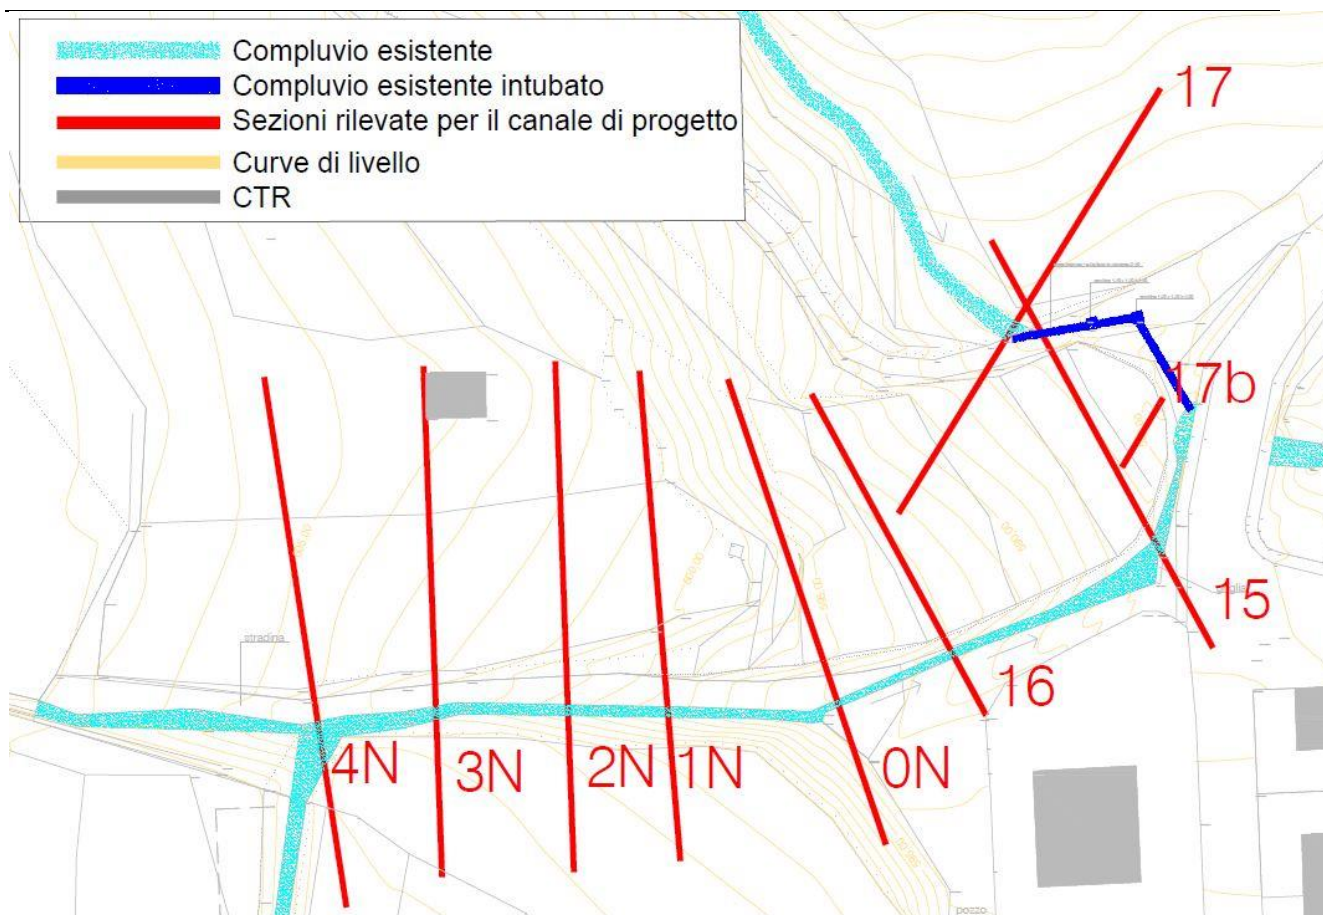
Planimetria dei canali oggetto di intervento.
